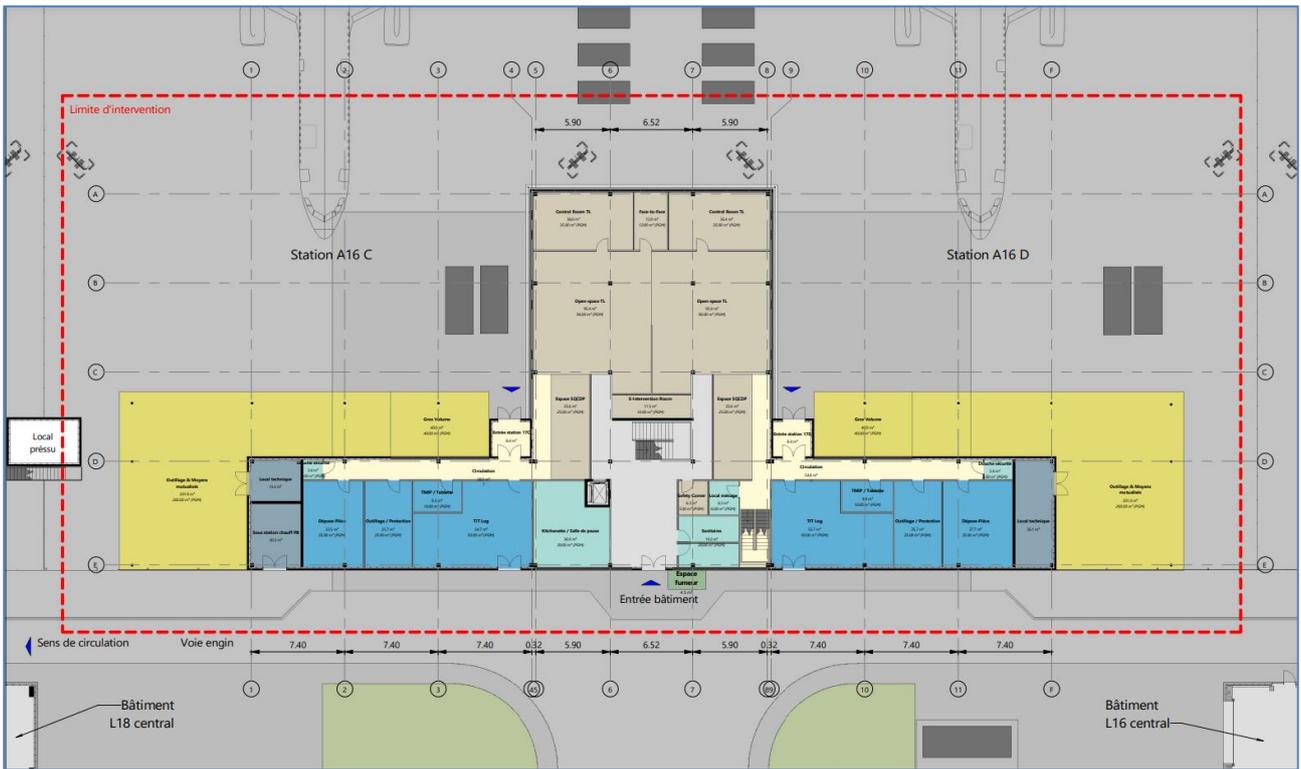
Plan du bâtiment annexe (appelé L17) du projet L14 sur le site Jean-Luc Lagardère
